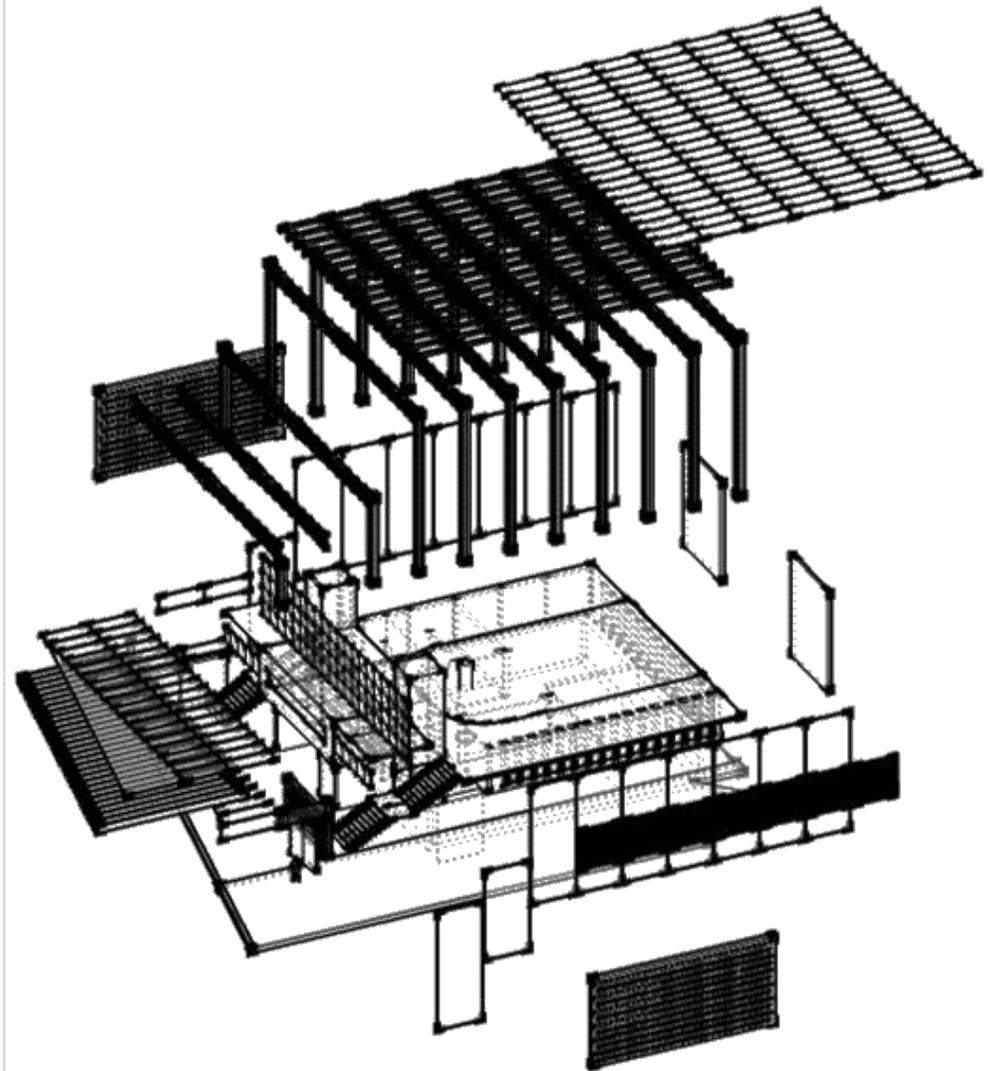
Modelo 3D de la estructura de la estación
